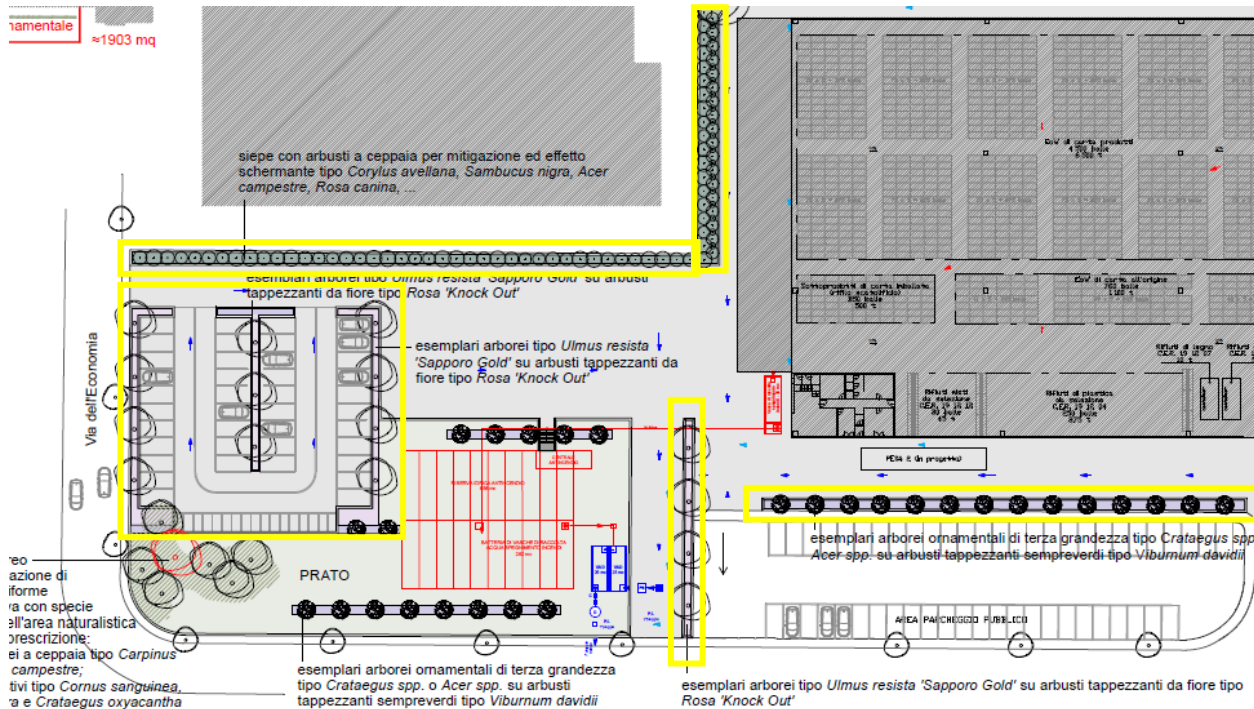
Estratto planimetrico progetto del verde – Stralcio 3 evidenziato in giallo.
